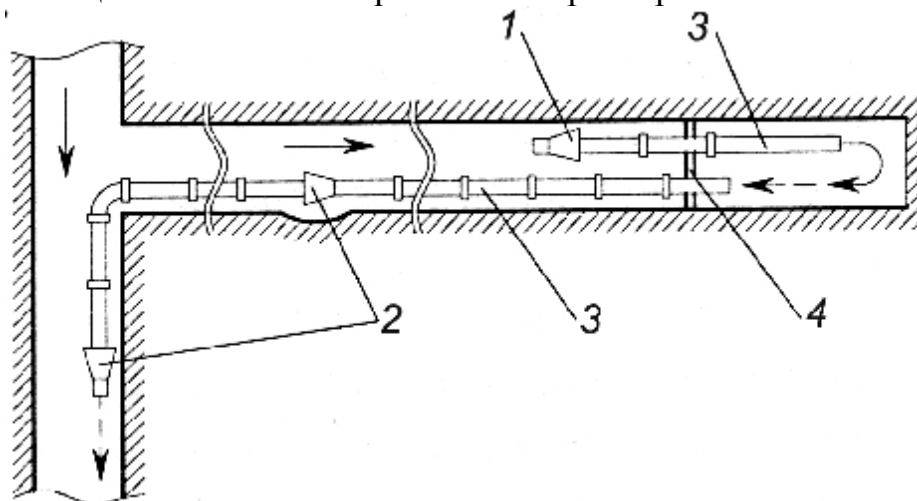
Комбинированное проветривание двумя вентиляторами с перемычкой: 1 – нагнетательный вентилятор; 2 – всасывающий вентилятор; 3 – трубопроводы; 4 – перемычка.
